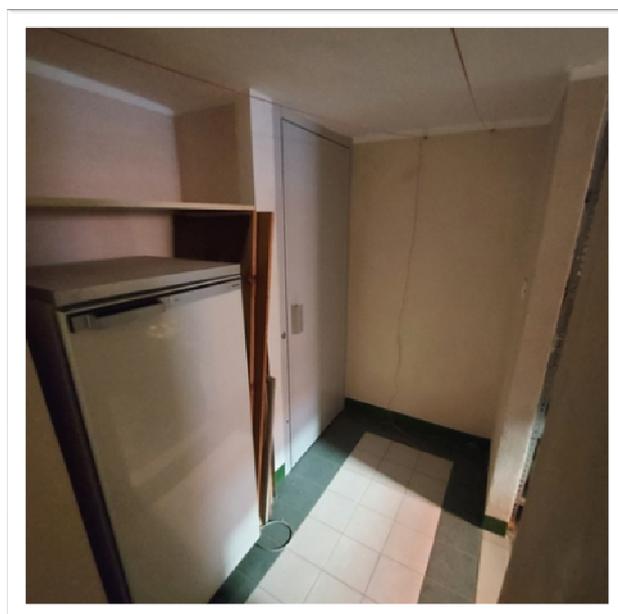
P.Sem. distribuzione (part. piattaforma elevatrice)
